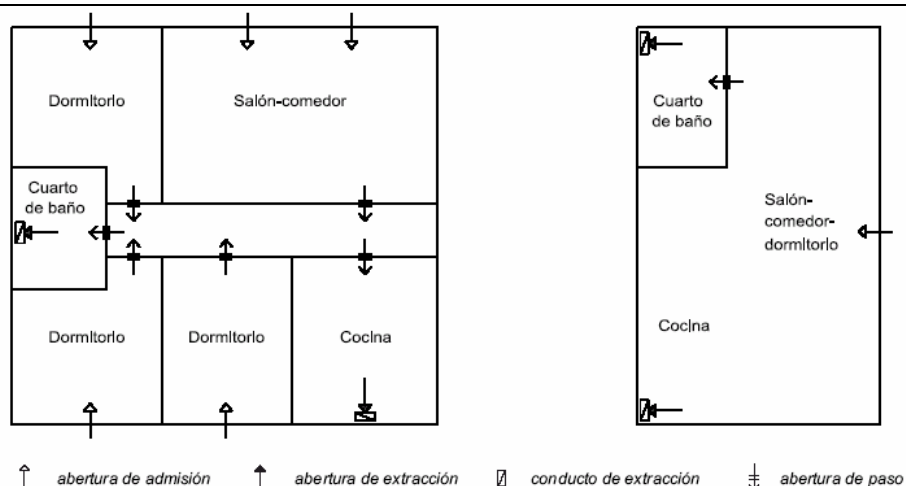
Ejemplos de ventilación en el interior de las viviendas
